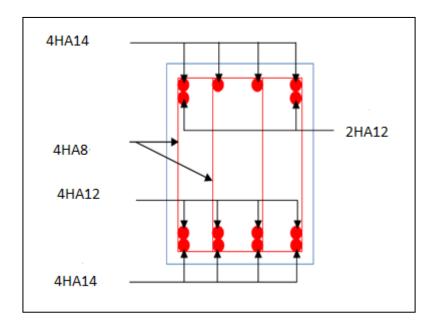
Schéma de ferraillage de la poutre brisée en travée.
